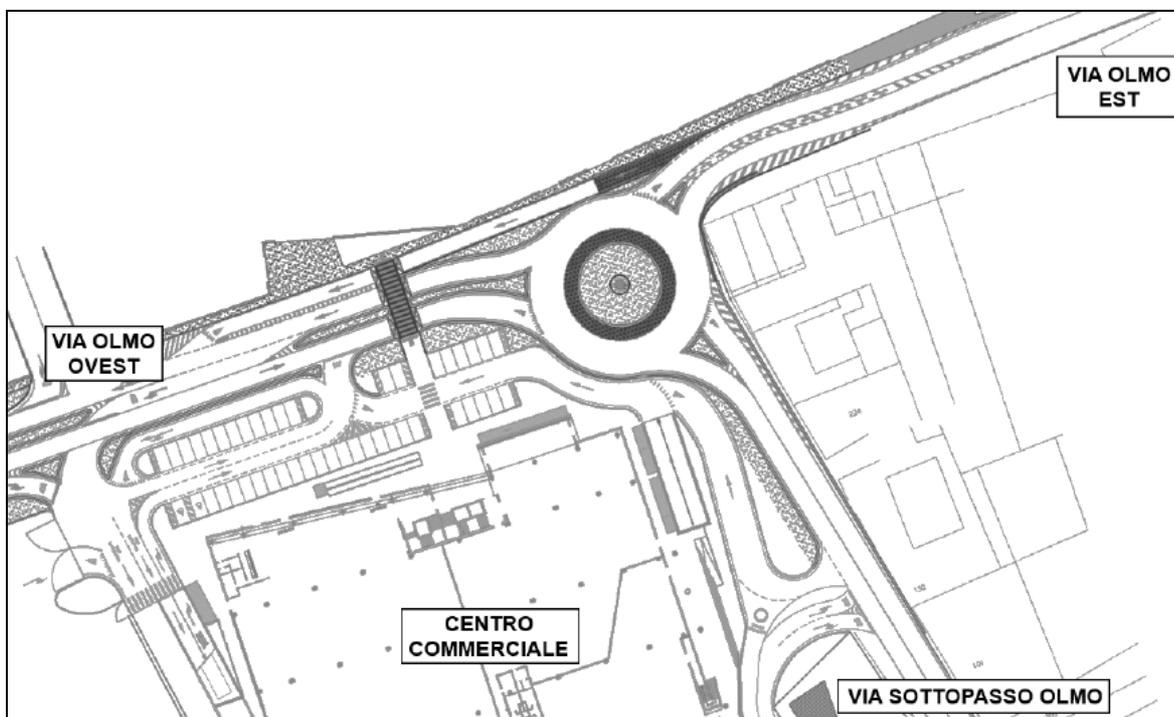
planimetria rotatoria tra SR 11 e via Sottopasso Olmo
